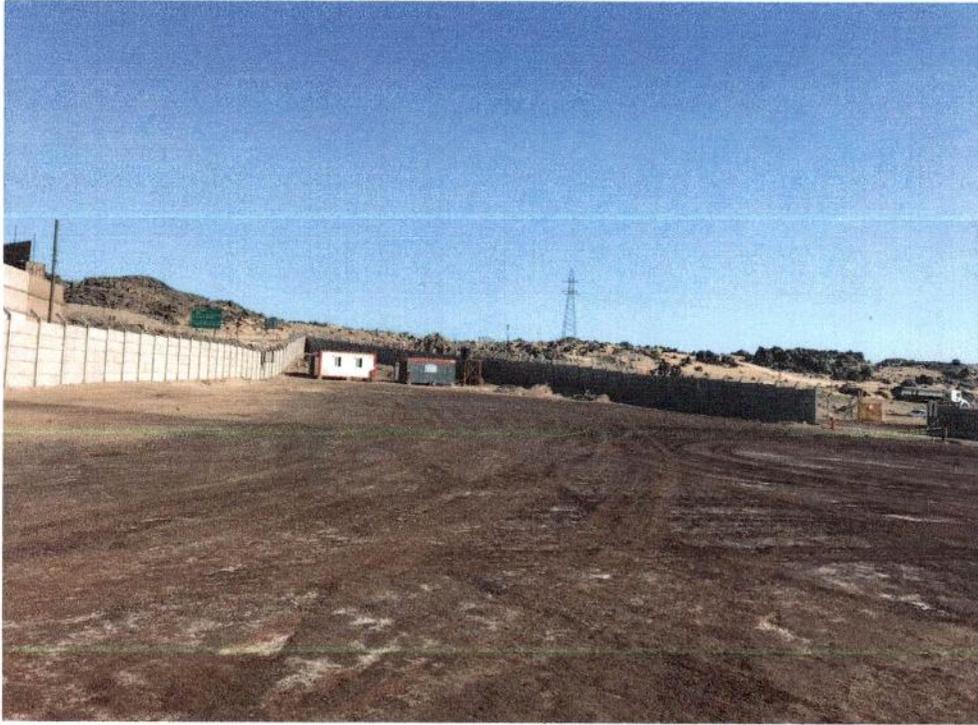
Foto de inspección faena 10.06.2021 – terreno ubicado en Camino Punta Caleta N°517, comedor y baños
